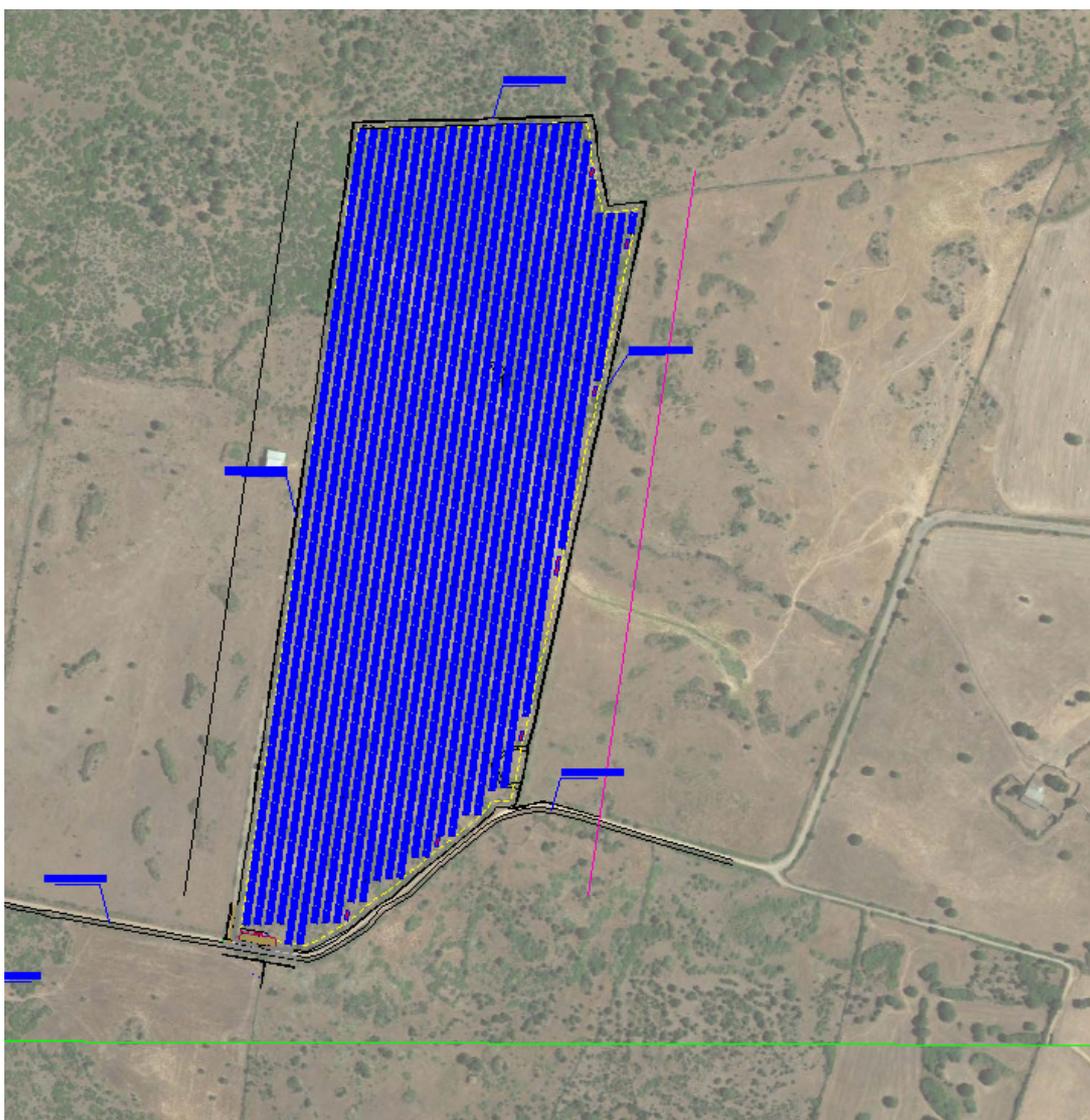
planimetria di progetto con indicazione dei pannelli e delle principali opere interessate dell'impianto
